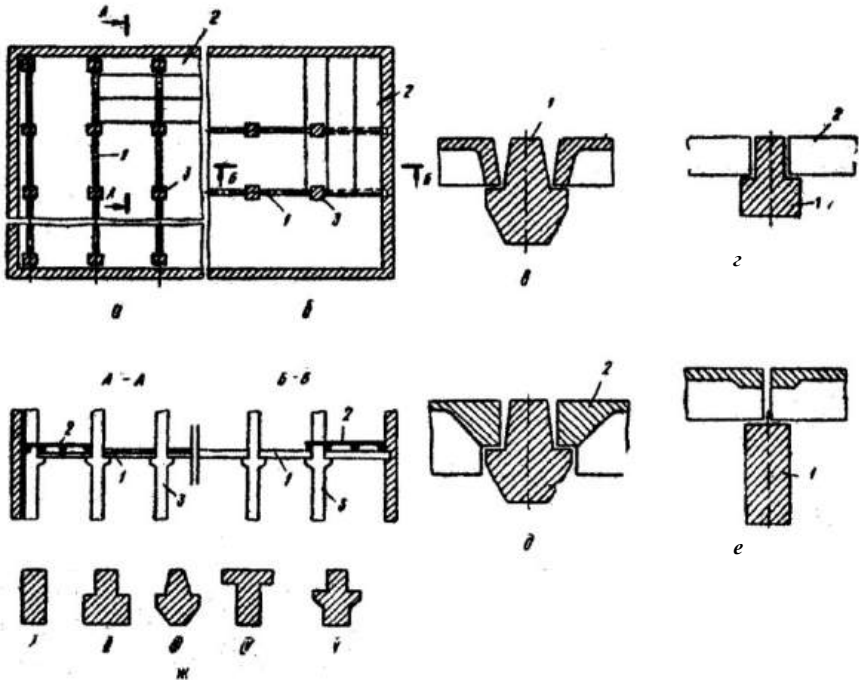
Збірне балкове перекриття: *а* – при повному каркасі; *б* – при неповному каркасі; *в* – опирання ребристих плит на полиці ригелів; *г* – те саме, пустотних плит; *д* – те саме, плит «подвійне Т»; *е* – ребристих плит по верху ригелів; *ж* – типи перерізів ригелів; *І* – прямокутний; *II...V* – таврові; *1* – ригель; *2* – плита; *3* – колона
